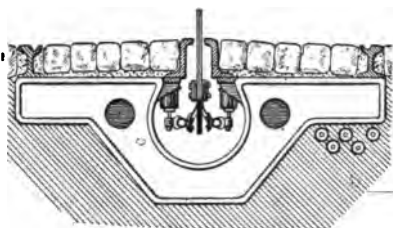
Caniveau de la General Electric Company. — Nouveau type.
